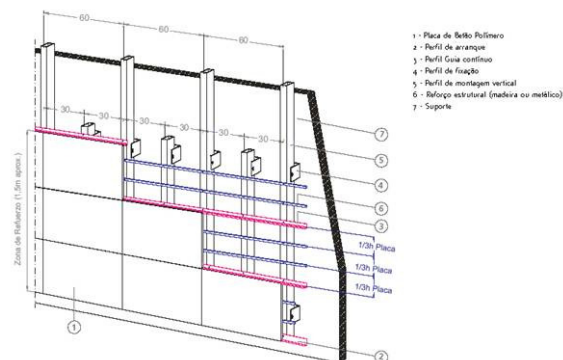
Esquema para fachada ventilada em betão polímero. [7]
